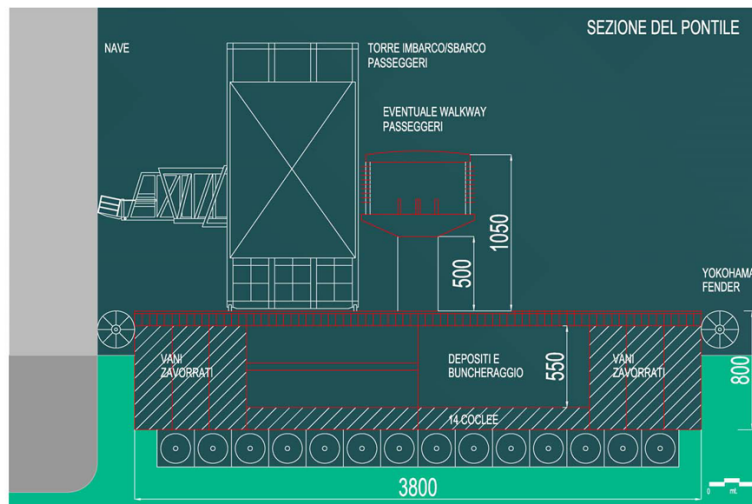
Sezione schematica dell’impalcato del molo galleggiante ancorato al fondo.
